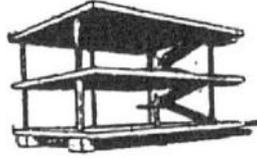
Representa el modelo “Domino”, que mediante una estructura de forjados y pilares de hormigón armado permitía liberar la fachada de la estructura, para poder componerla libremente.
